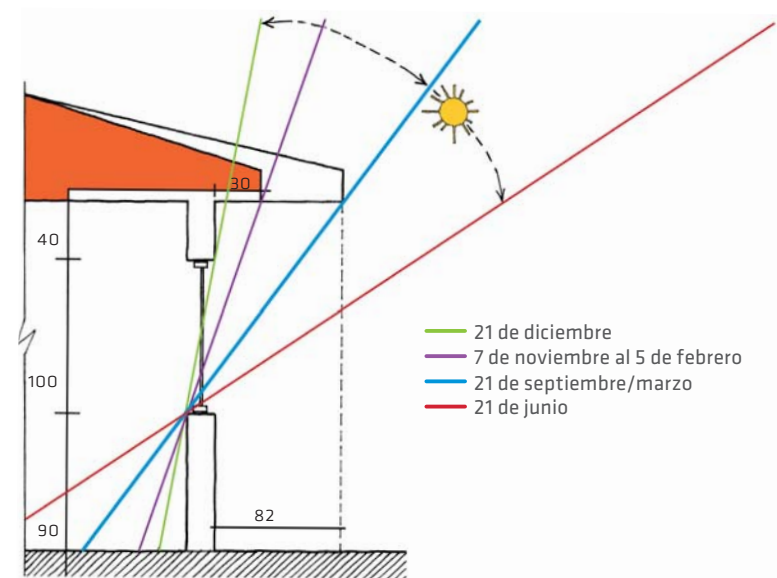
Dimensionamiento de protección solar horizontal norte para latitud 33° (Valparaíso).
